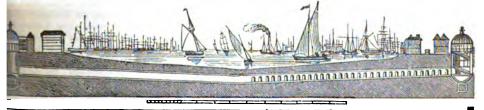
Coupe en long du tunnel sous la Tamise.
